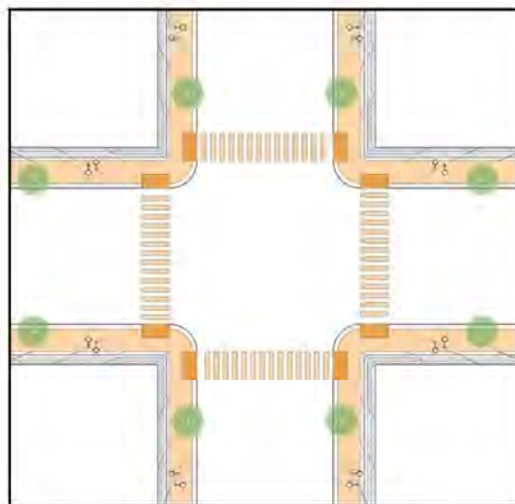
14. Planta especificando la ubicación de colocación de rampas peatonales.
